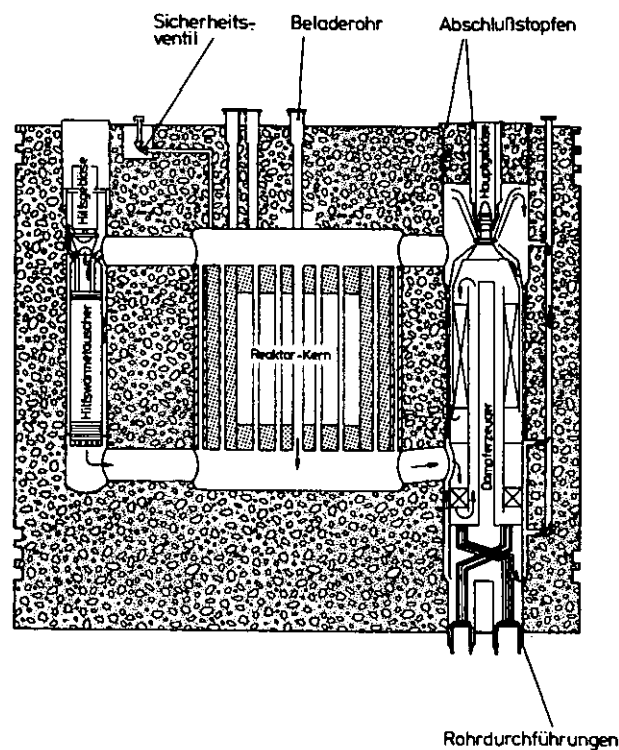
Primärkreislaufabschlüsse und -durchführungen
